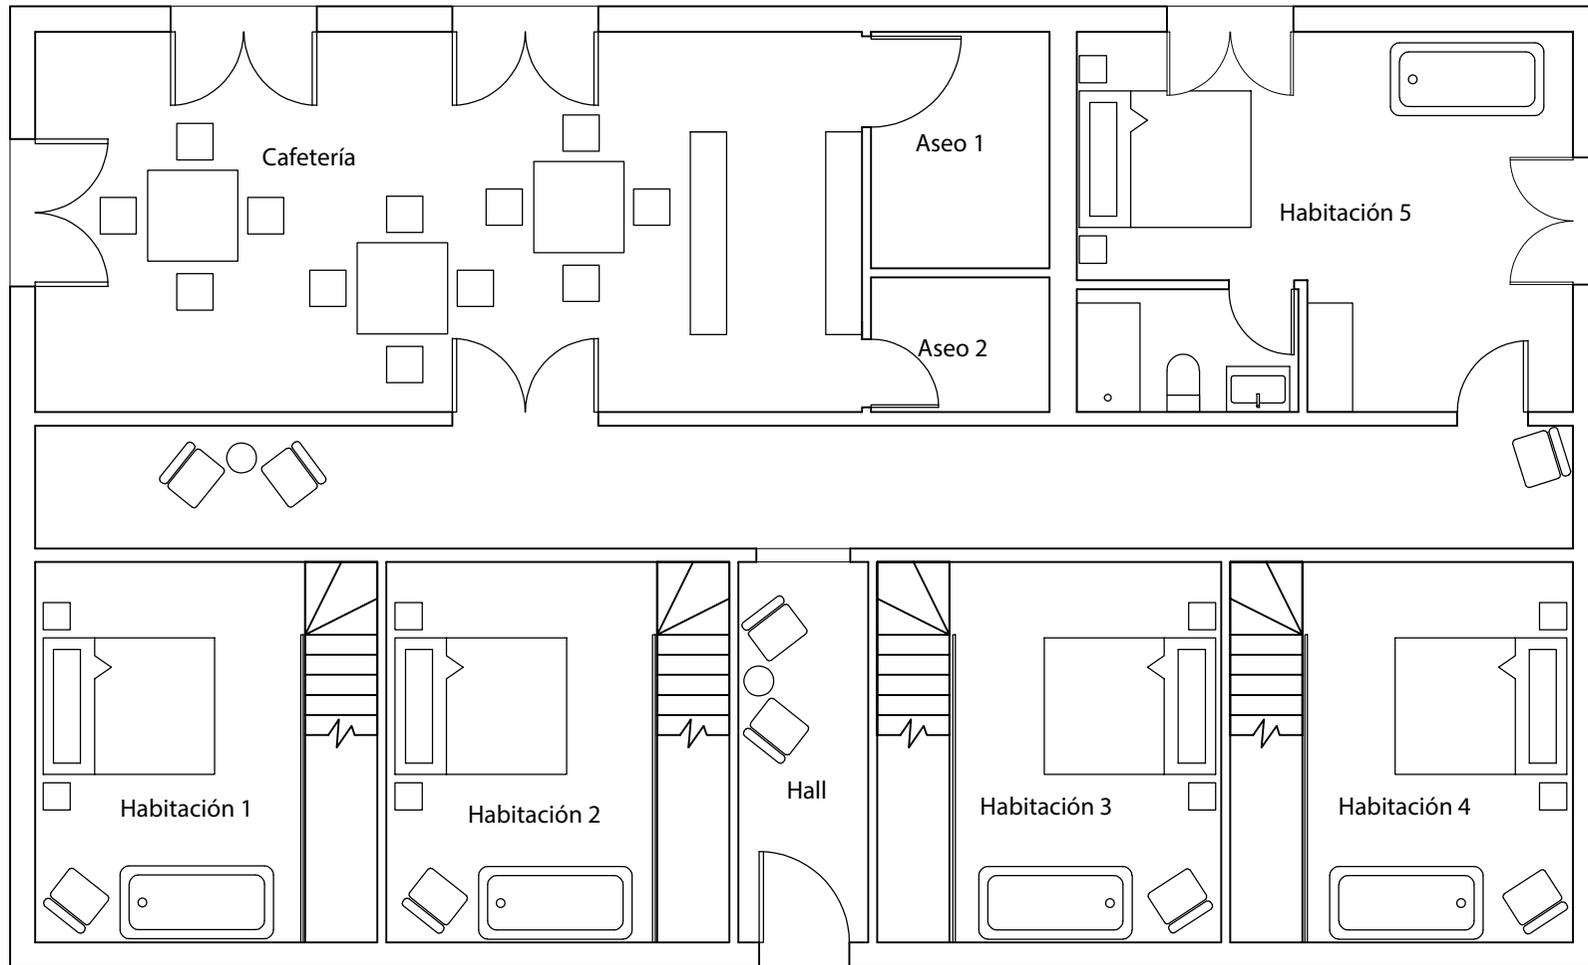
Plano Hotel trinidad. Planta alta. Sin escala
